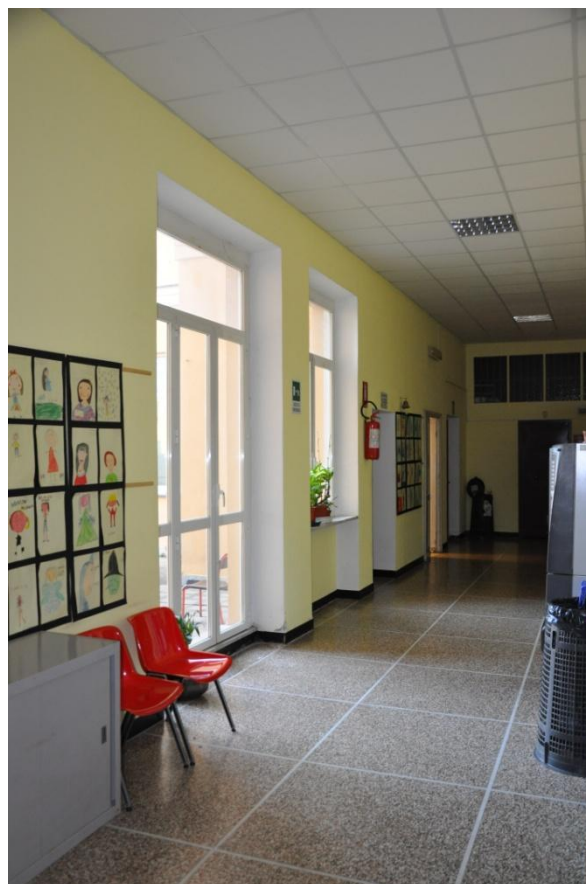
Particolare del solaio del terzo piano lato scuola primaria
